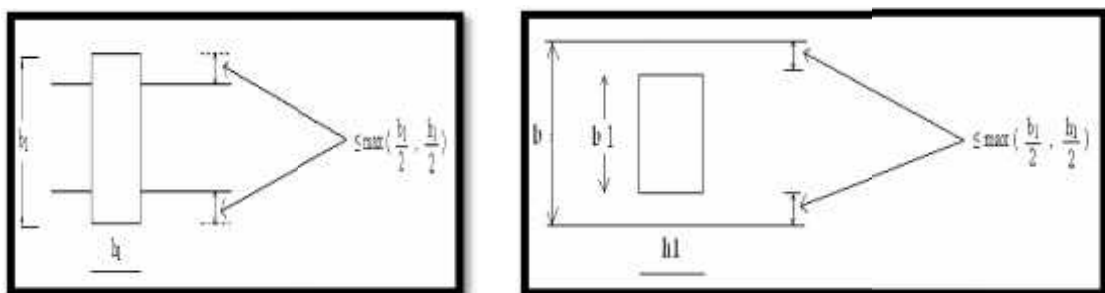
Dimensions à respecter par les poutres selon RPA 99 v-2003
